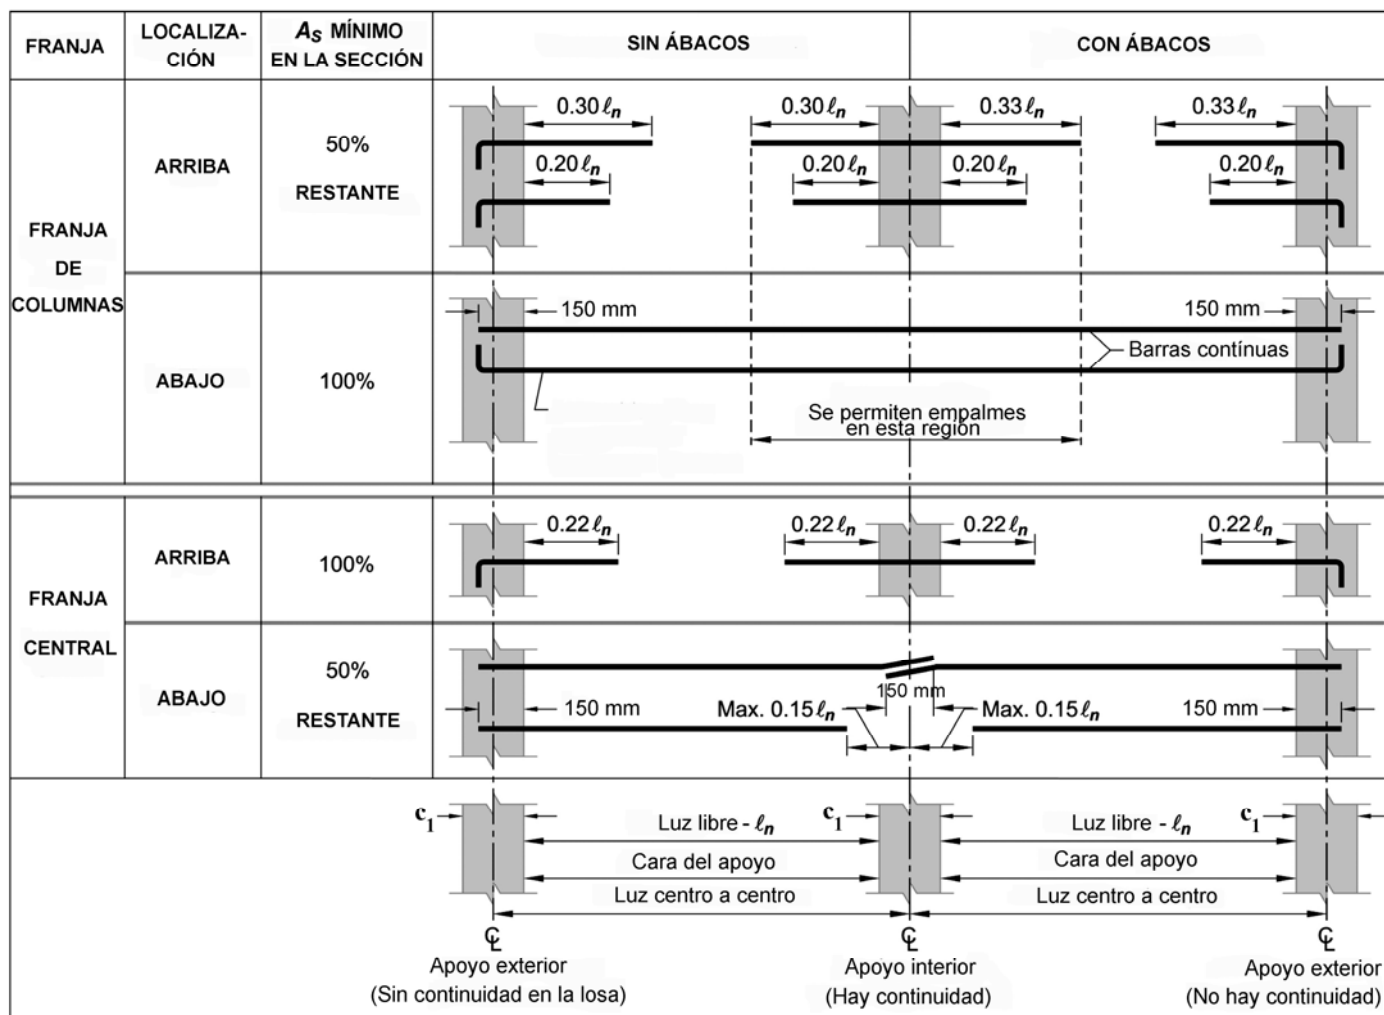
Extensiones mínimas del refuerzo en losas sin viga. (Véase C.12.11.1 para las extensiones dentro de los apoyos)
